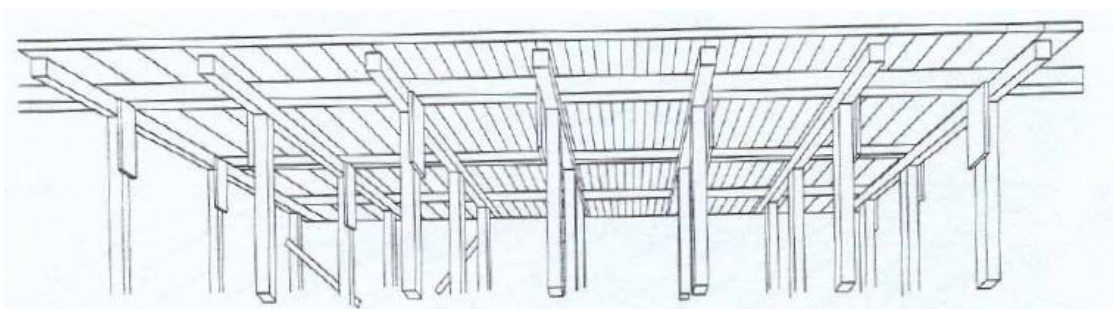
Cofragem tradicional de uma laje vista de baixo (Lança 2007).
